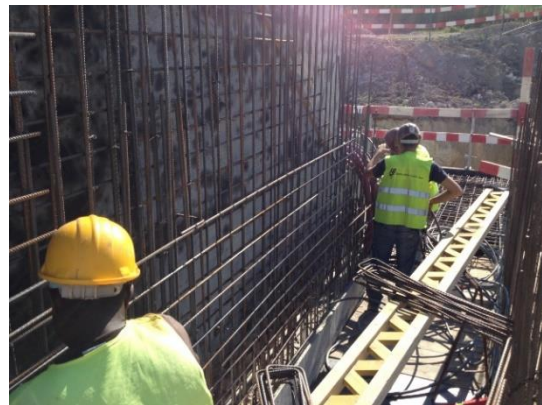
Colocação de painéis em betão armado nervurados pré-fabricados (06-07-2015)
